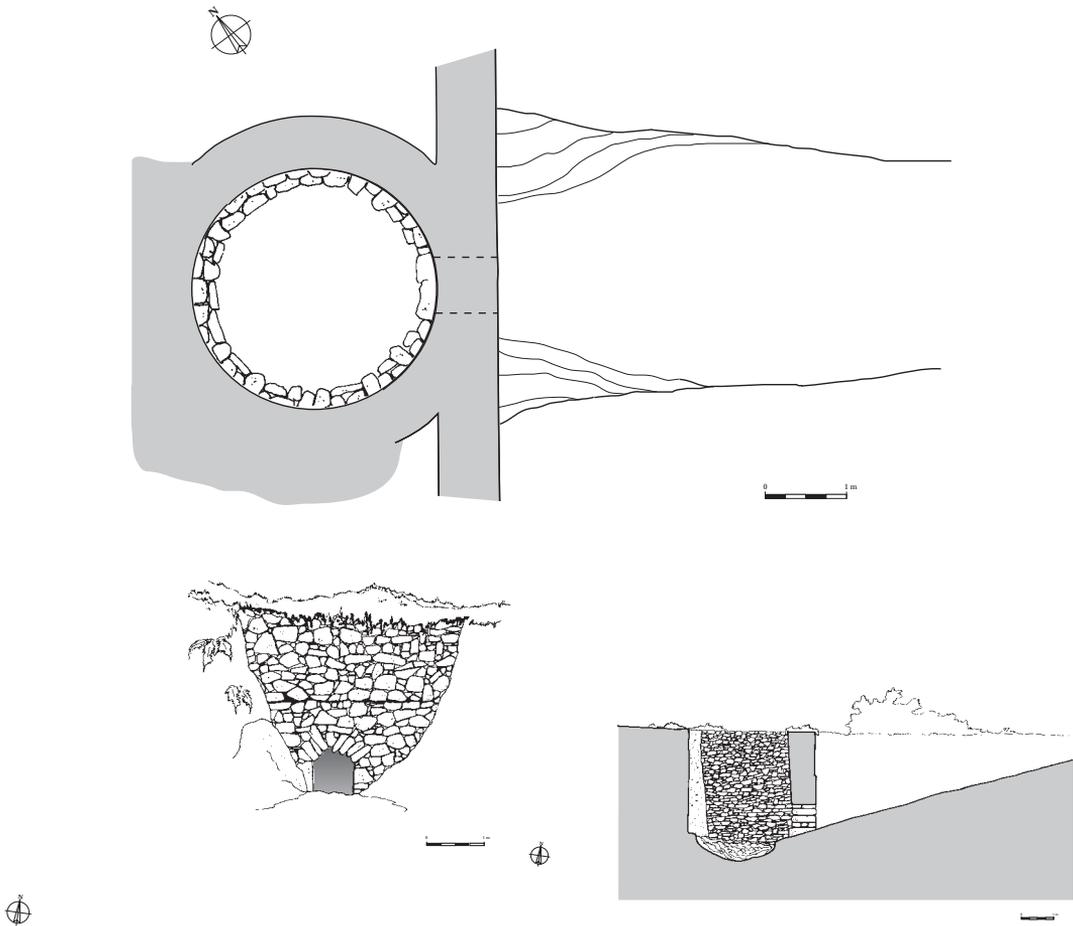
Planta, alzado y sección del calero de Folgueras (Villaperi, Oviedo).
